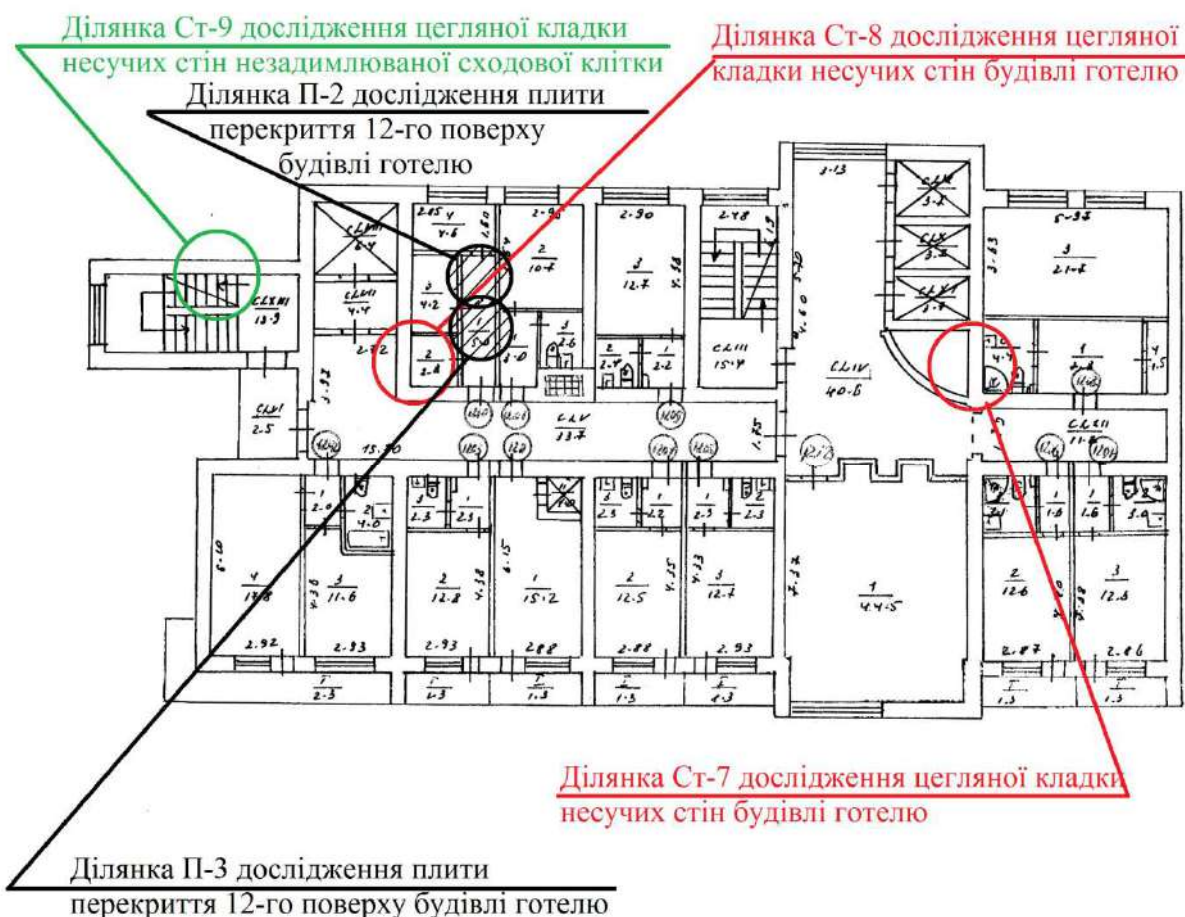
Схема розташування ділянок інструментального обстеження несучих конструкцій 12-го поверху будівлі готелю
